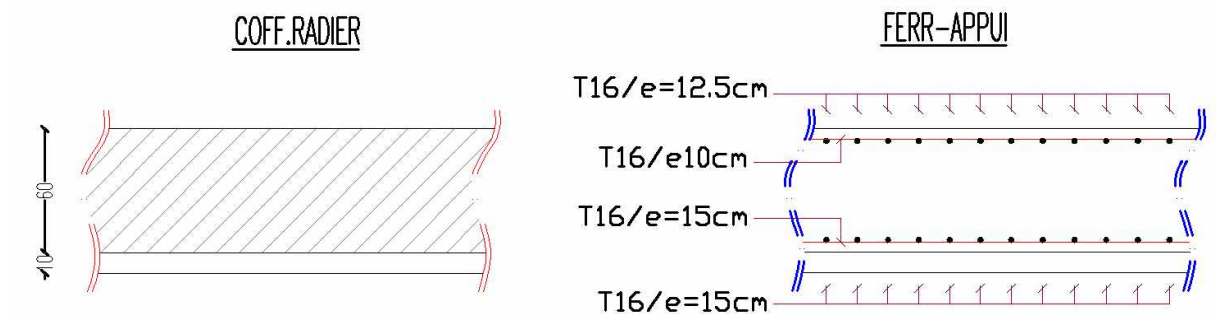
Schéma de ferrailage de radier en appui
